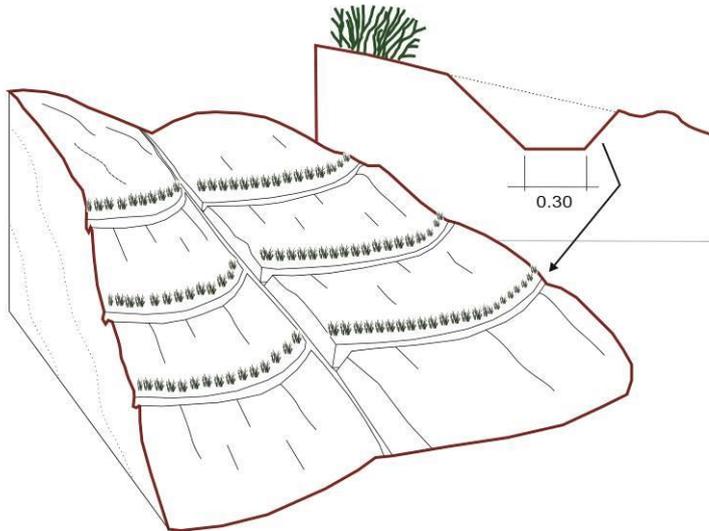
Sistema de drenaje en laderas ocupados por cultivos
